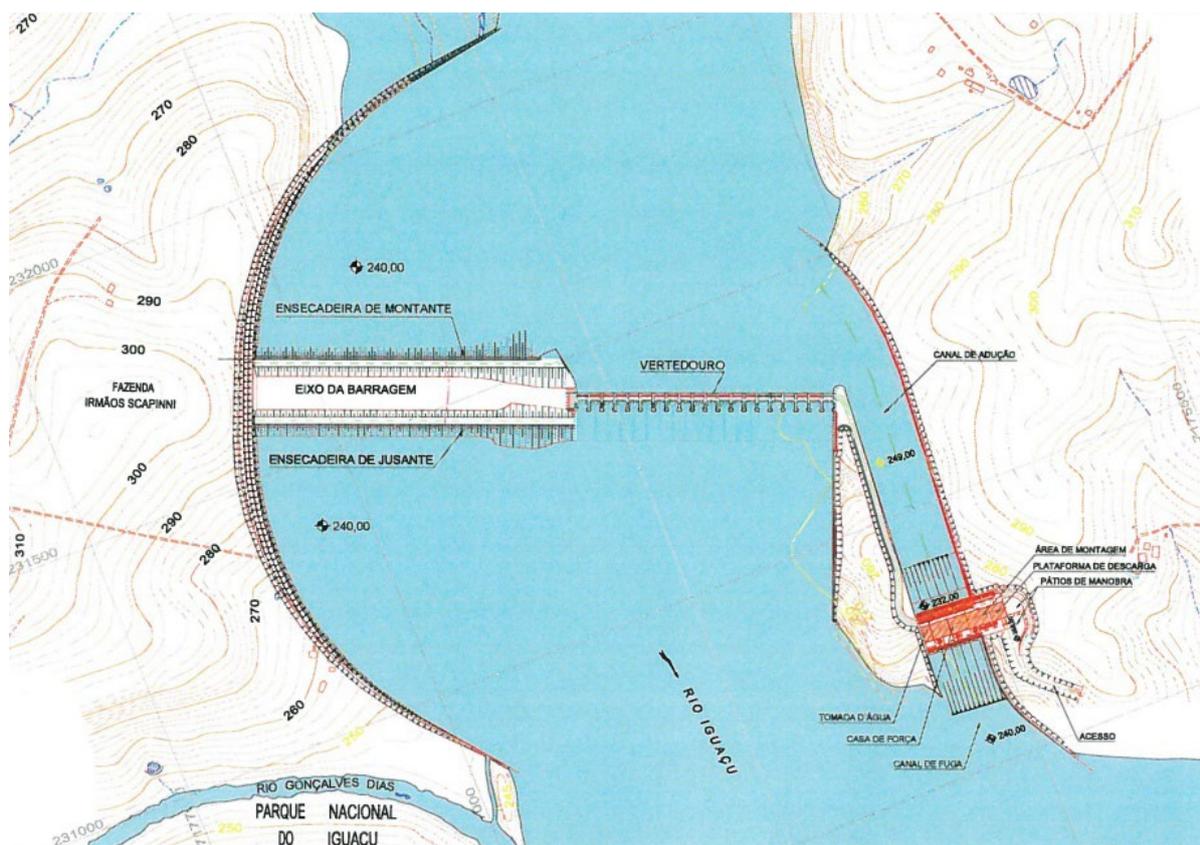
Desvio do rio em diversas fases. 2ª Fase. Desvio pelo vertedor, com uso de ensecadeira incorporada de montante e de jusante. UHE Baixo Iguaçu, PR.
